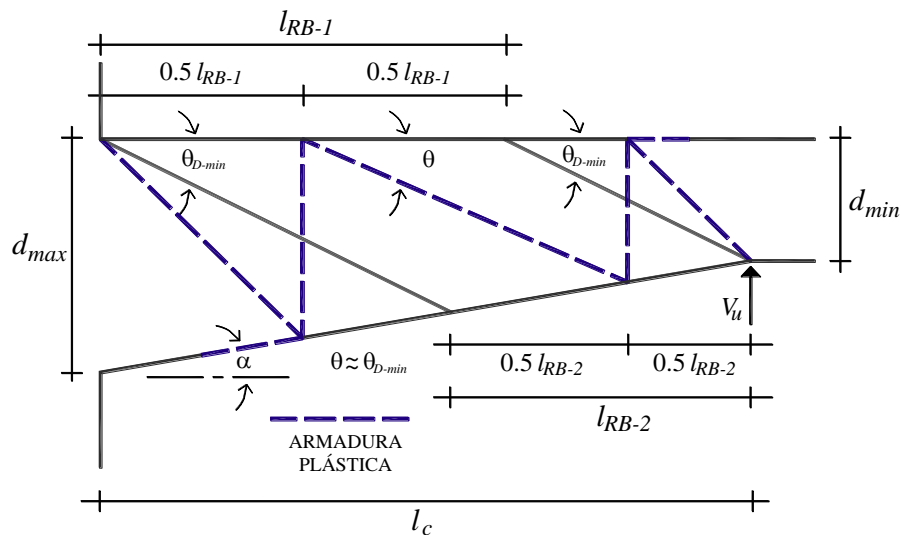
Modelo de armadura sugerido para analizar las traves acarteladas con refuerzo transversal (carga antigravitacional)
